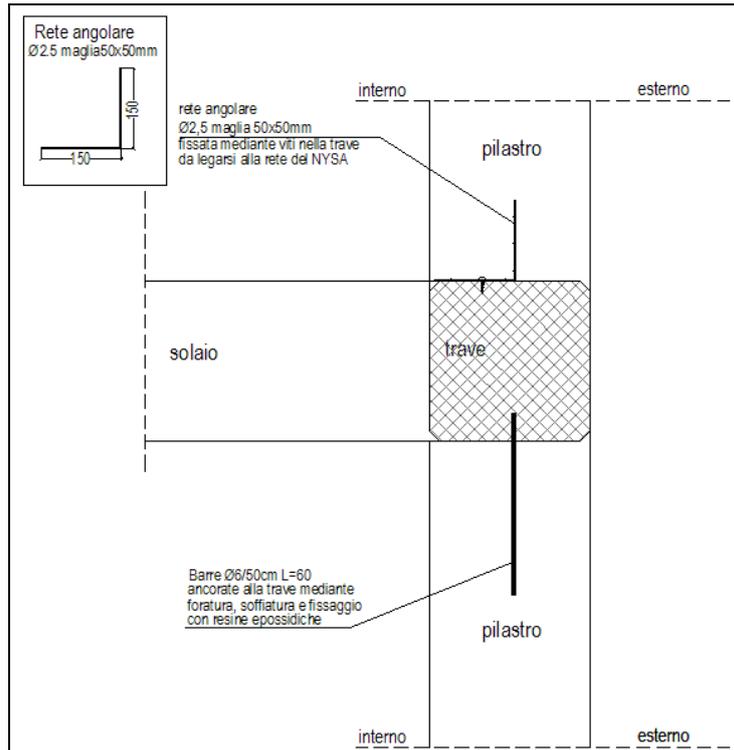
Fase 1 - -Casi A e C: sezione verticale del collegamento.
